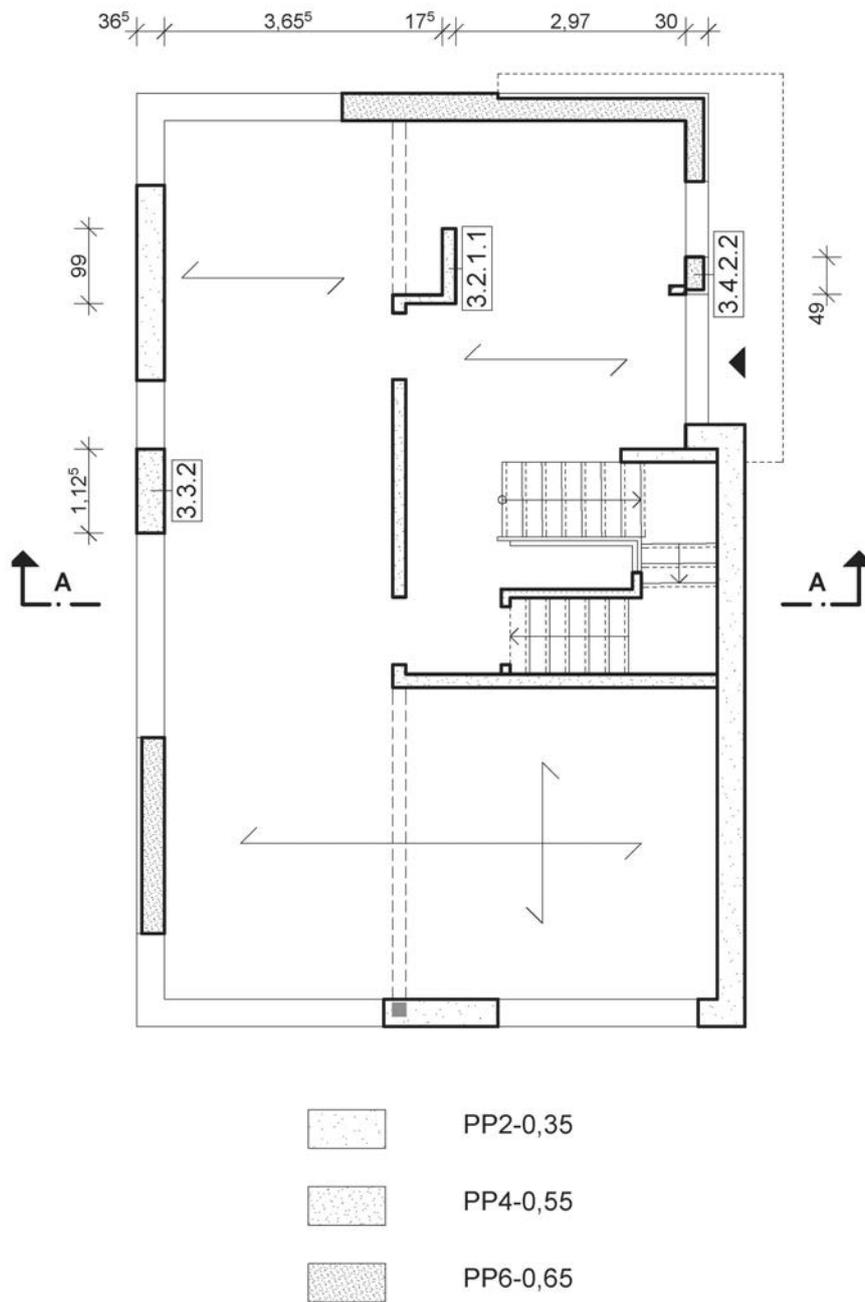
Einfamilienhaus in Berlin, Grundriss Erdgeschoss
